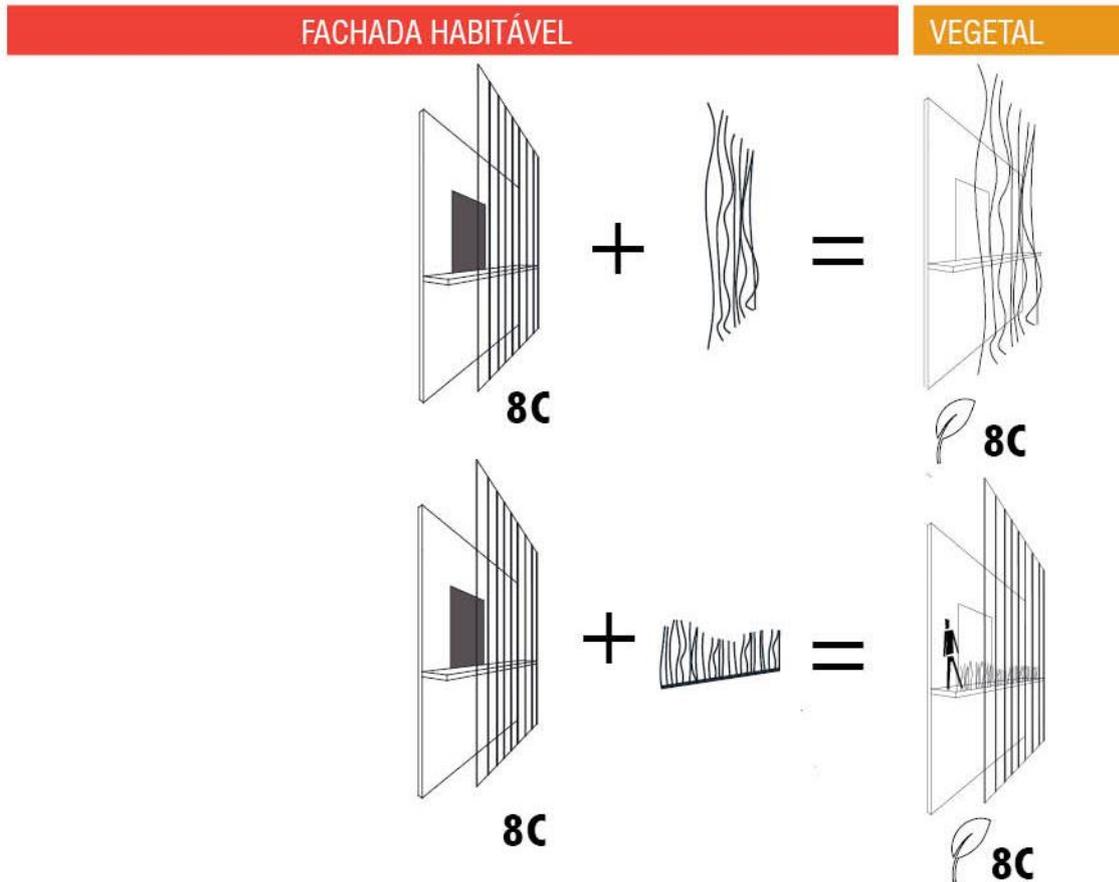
Fachadas Habitáveis – Camadas da envolvente construtiva – Parte III
